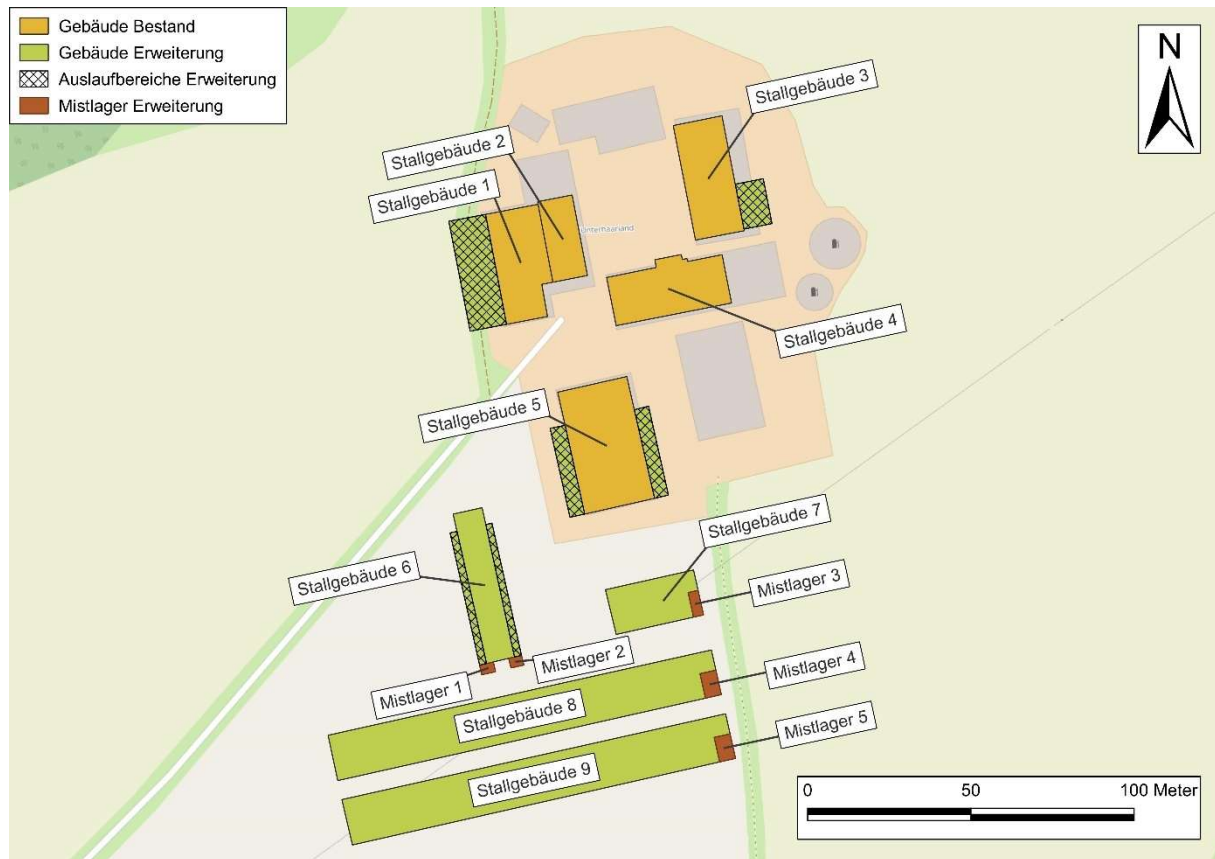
Lageplan mit Übersicht der Stallgebäude des Betriebs Jaud. Kartengrundlage: Daten von OpenStreetMap - veröffentlicht unter ODbL
